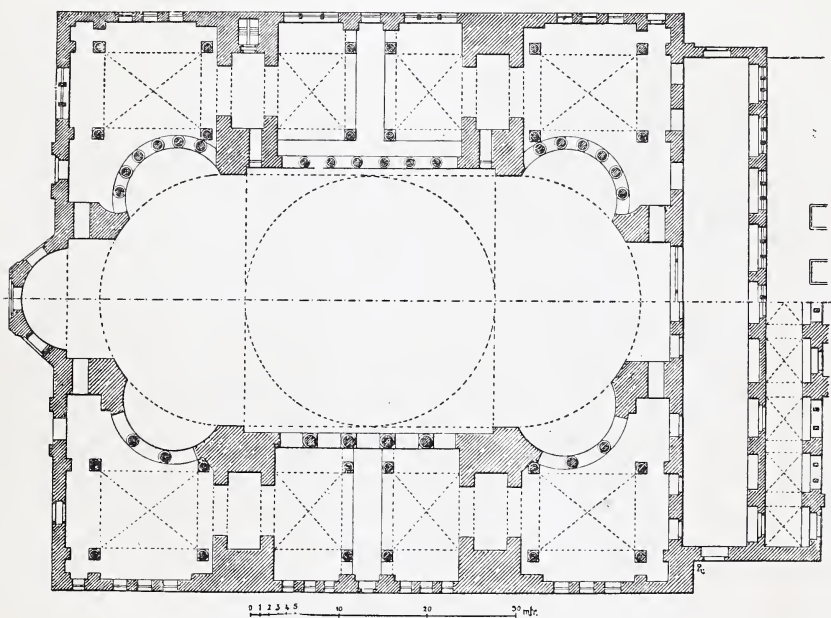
Grundriss der Sophienkirche zu Constantinopel.
